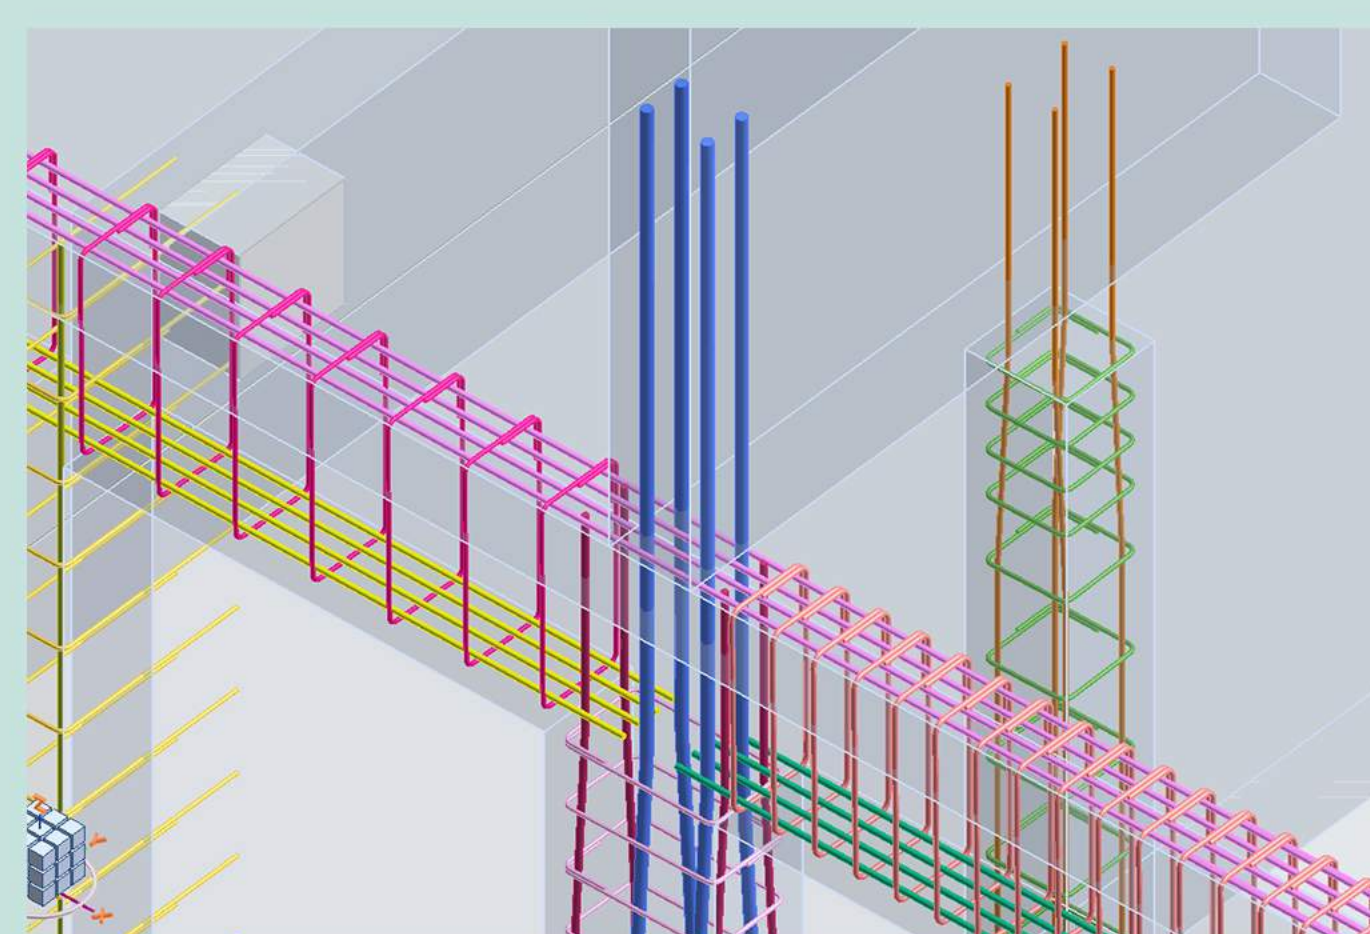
3D – Bewehrung, Knotenpunkt Stütze / Unterzug
